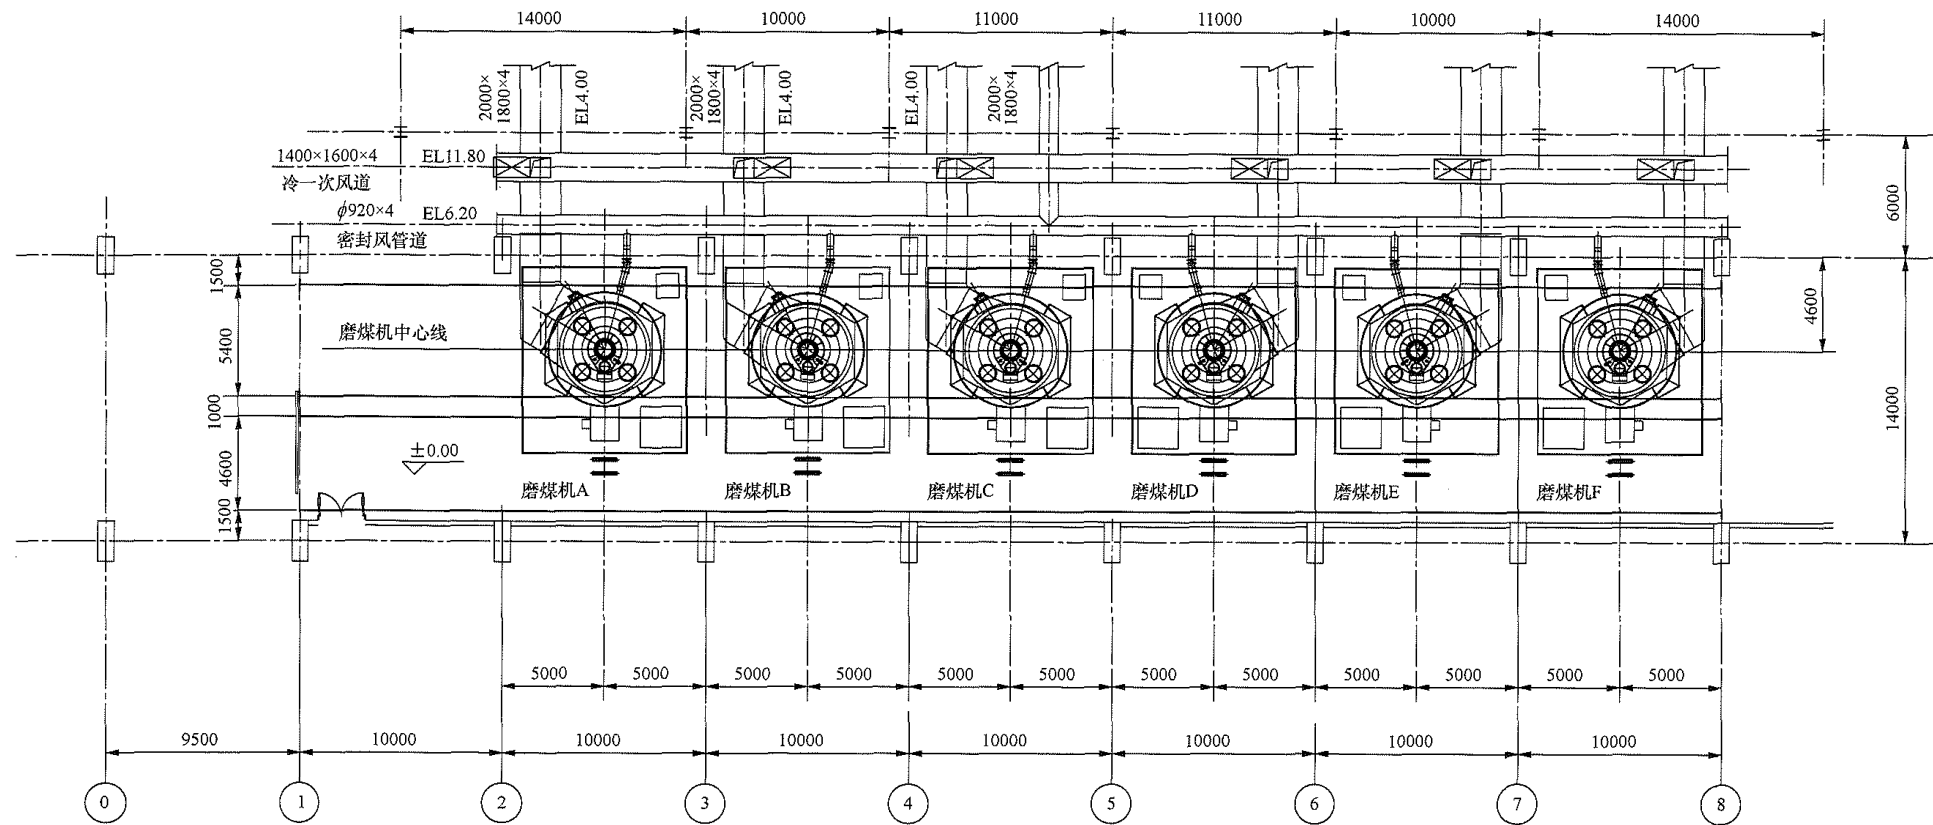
MPS 轮式磨煤机前煤仓方案平面布置示意图
